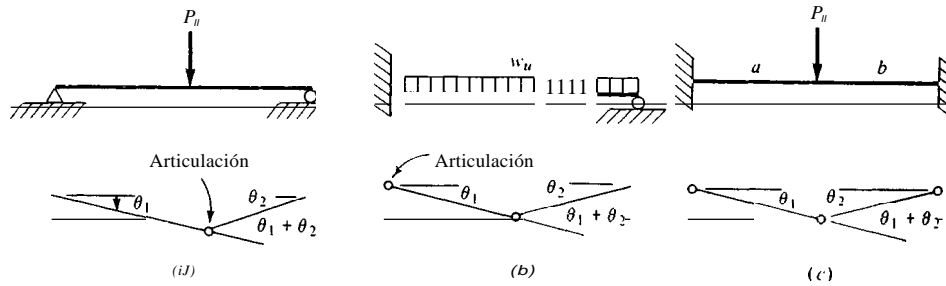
Formación de articulación plástica para diversas vigas cargadas como se muestra. (a) Viga simplemente apoyada, una articulación para la falla. (b) Viga en voladizo apuntalada, dos articulaciones para la falla. (c) Viga con extremos fijos, tres articulaciones para la falla.
